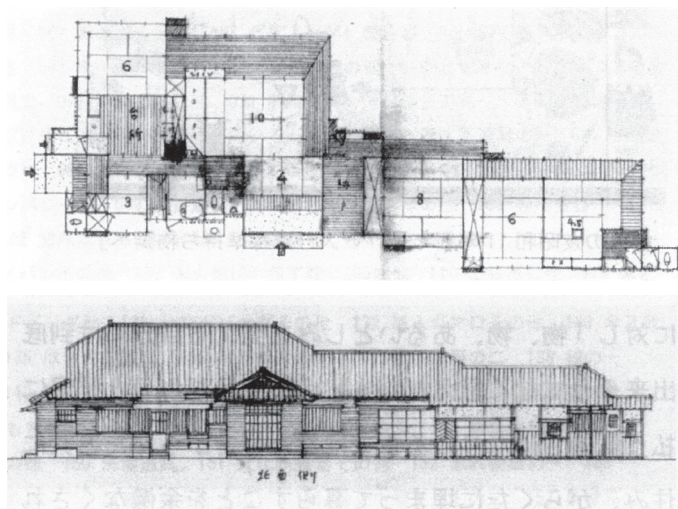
今和次郎が設計した横須賀市大津の家の平面図(上)と立面図
